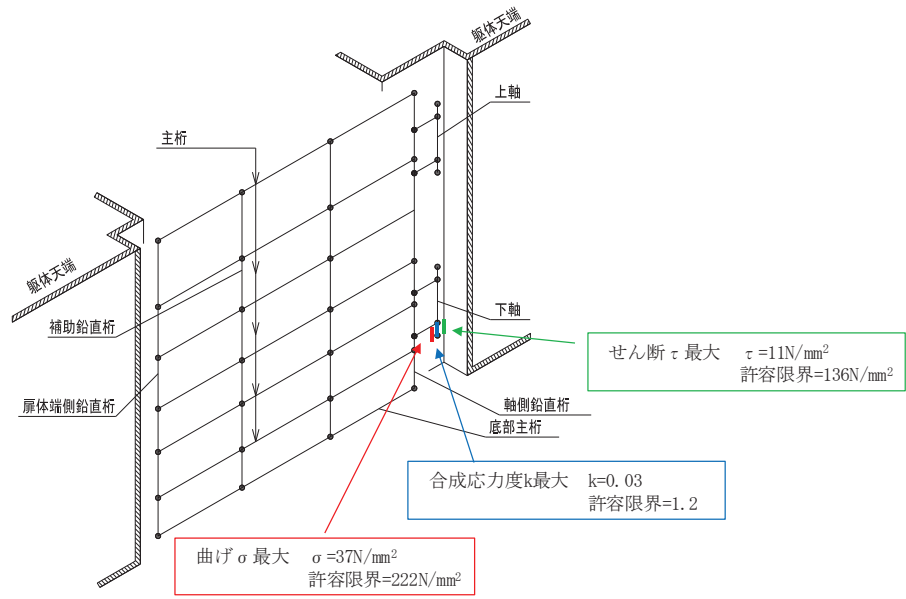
(3) ヒンジの曲げ・軸力系の破壊およびせん断破壊に対する
